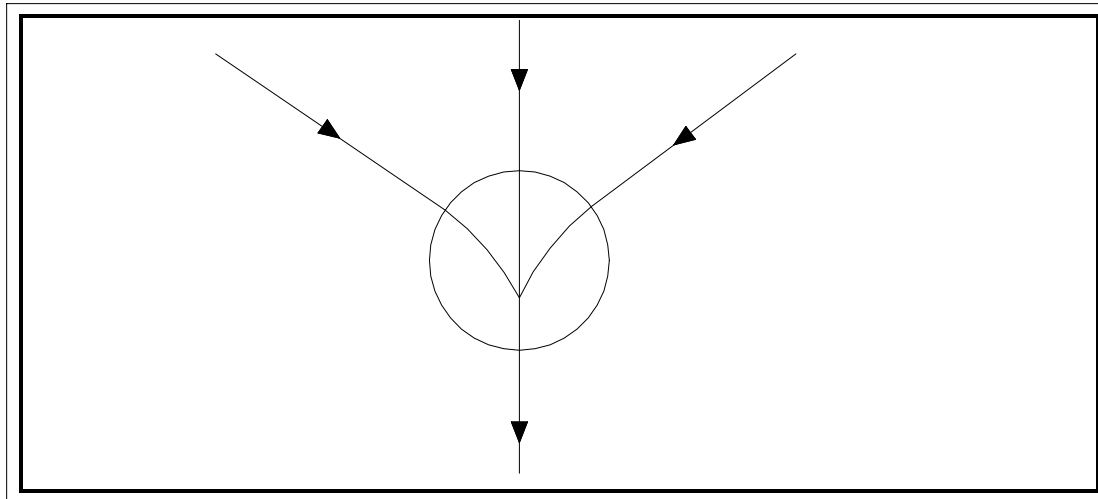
Boca de Registro en Intersección de Cañerías (Apunte Ingeniería Sanitaria)
